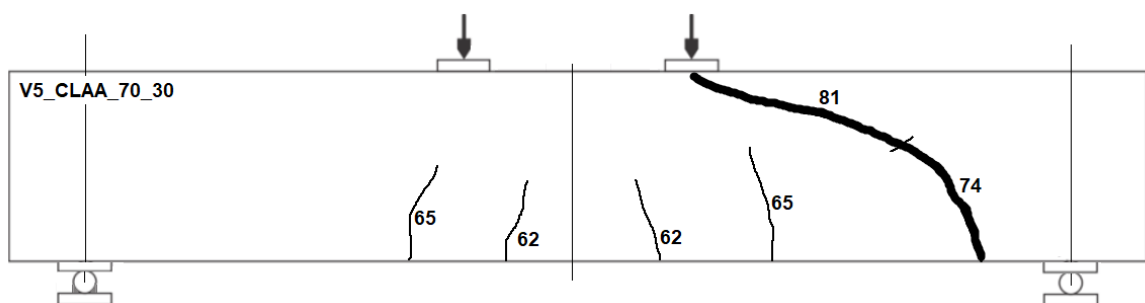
Esquema de fissuração da Viga 5_CLAA_70_30.
